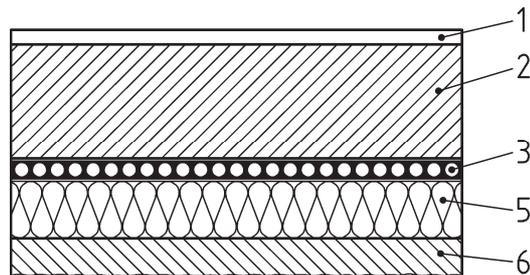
System mit Rohren unter dem Estrich Typs B
